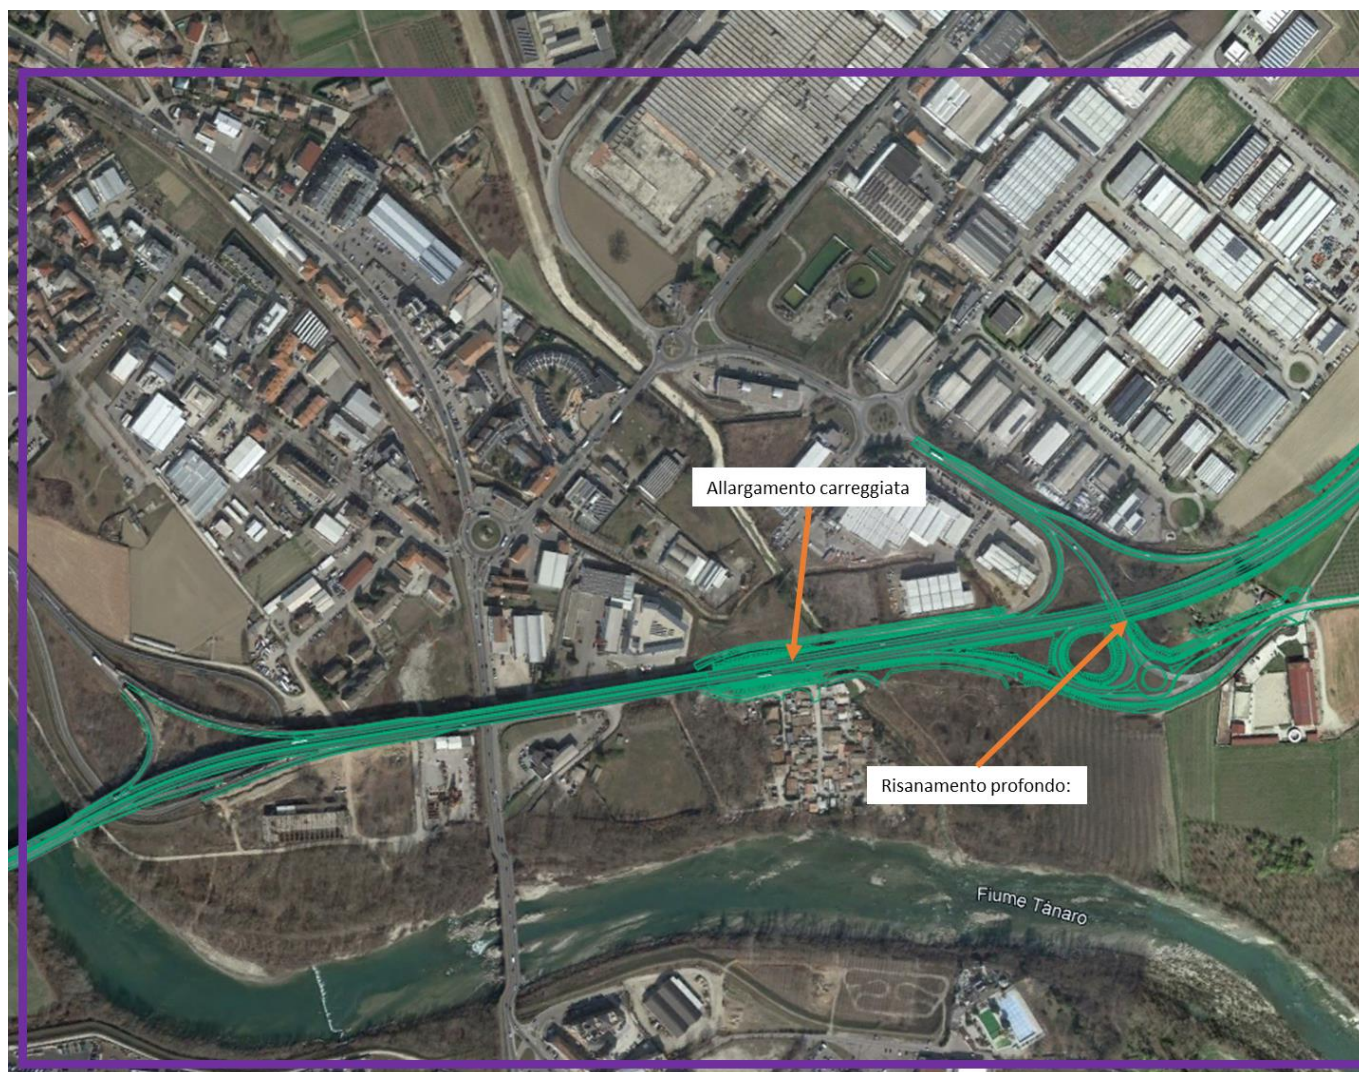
Rappresentazione delle aree di cantiere Scenario
